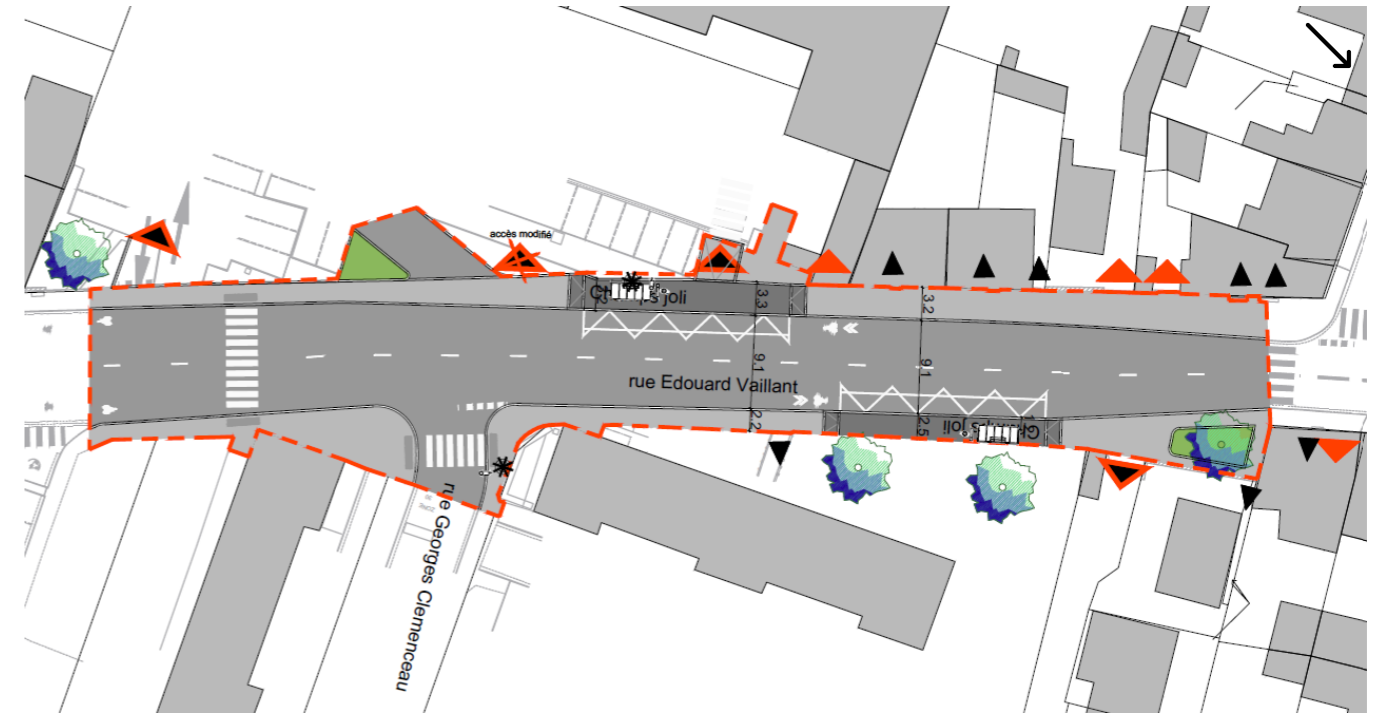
VUE EN PLAN PROJETEE – STATION CHAMP JOLI
